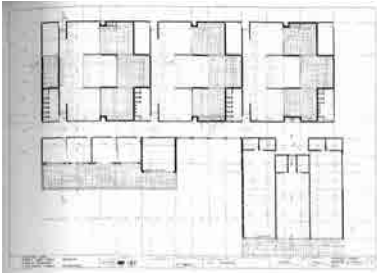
Planta del área de aulas vinculadas a patios del Centro de Almería.
